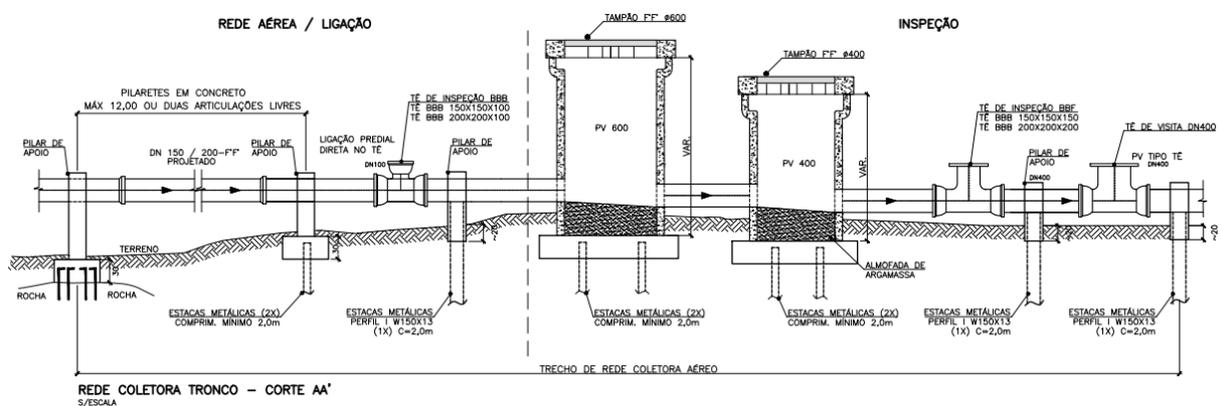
Detalhes do projeto padrão CESAN para redes beira rio (Bacia B).
